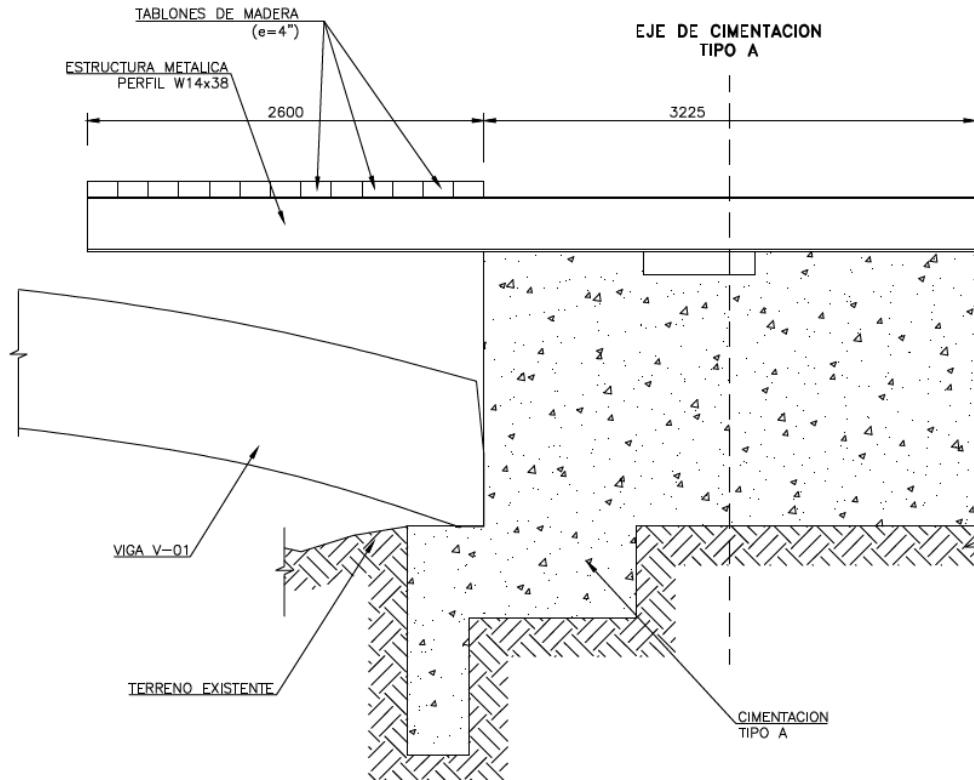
Distribuição das vigas metálicas na plataforma em Voladizo.
